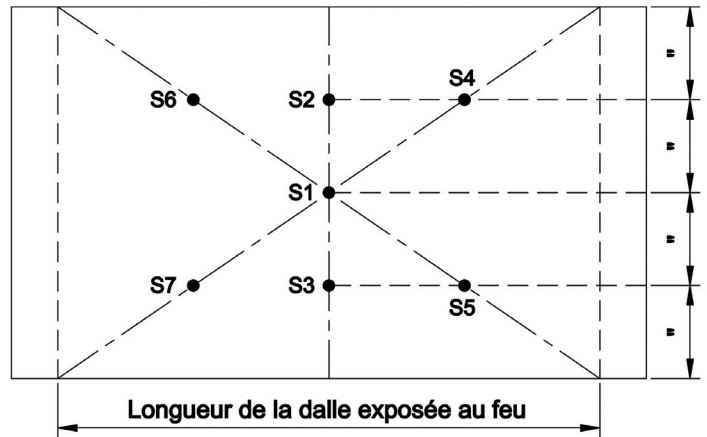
Positions des sections de mesures dans la dalle béton (vue en plan)
